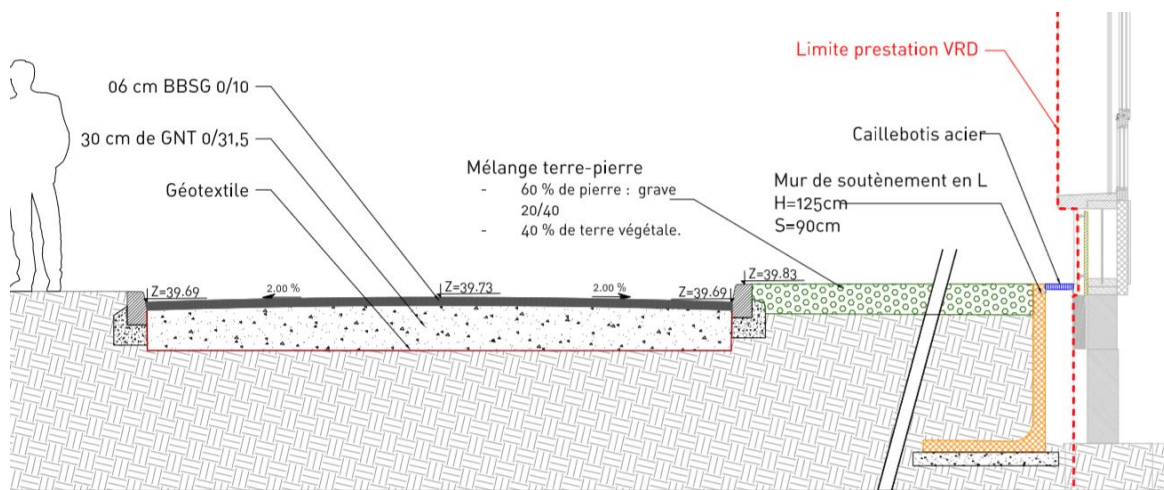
Coupe de détail mur de soutènement (Source : ATEVE Ingénierie)
